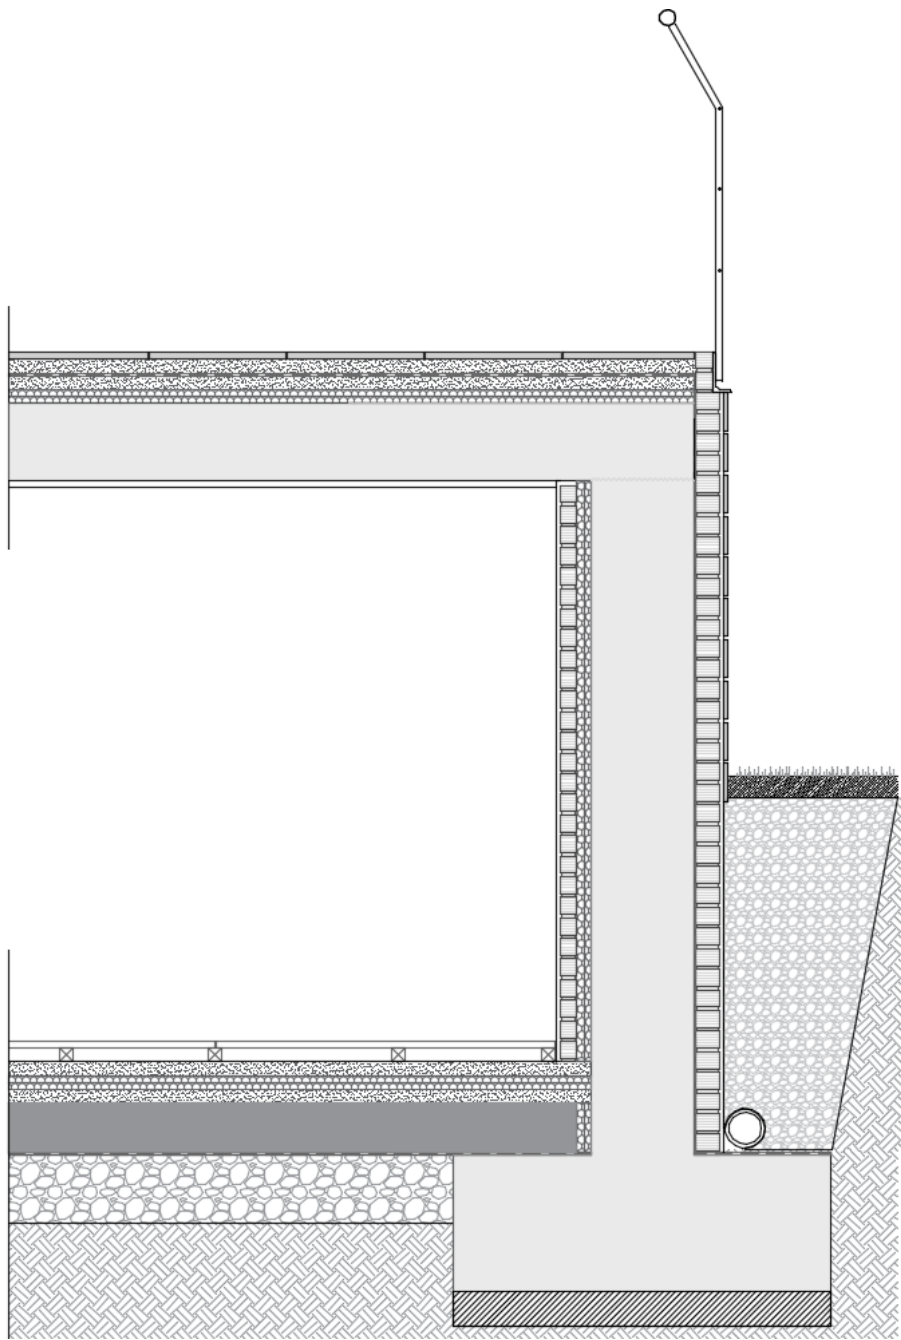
Sección constructiva del estrato inferior. Autor: Autoría propia
